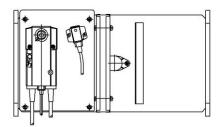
Seitenansicht BKA-EN (Federrücklaufantrieb)
